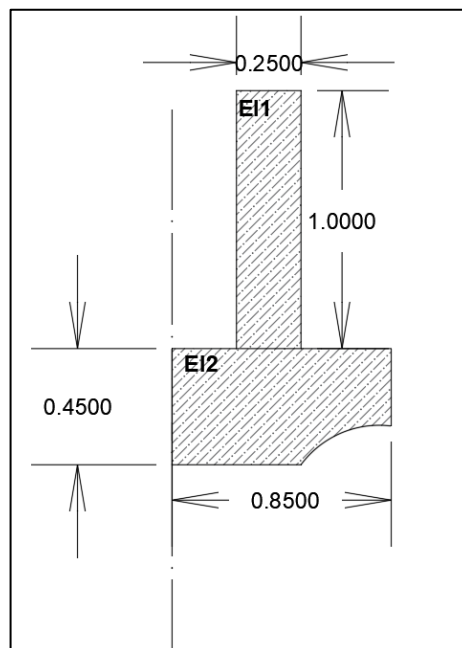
Corte transversal - Elementos de pedra salientes do plano vertical do muro de tímpano
